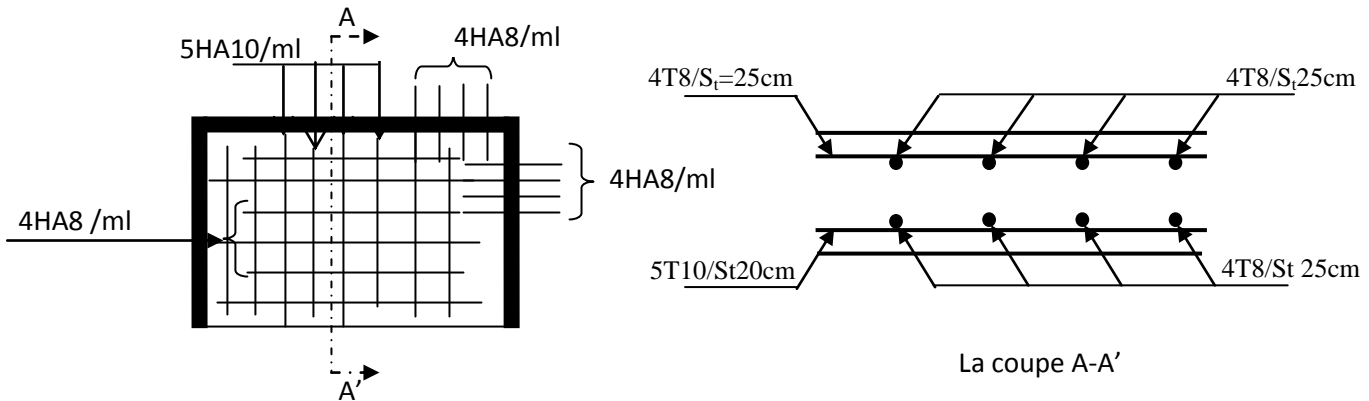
Schéma du ferrailage du balcon sur trois appuis
